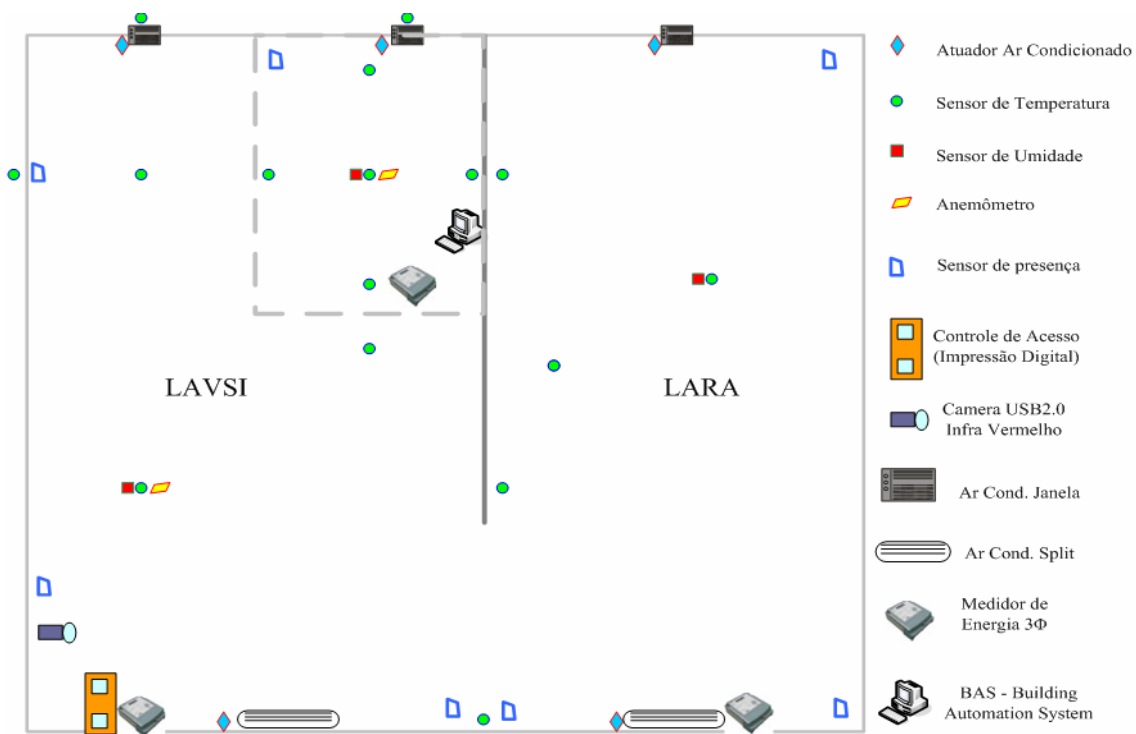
Disposição dos equipamentos na planta piloto [22].
